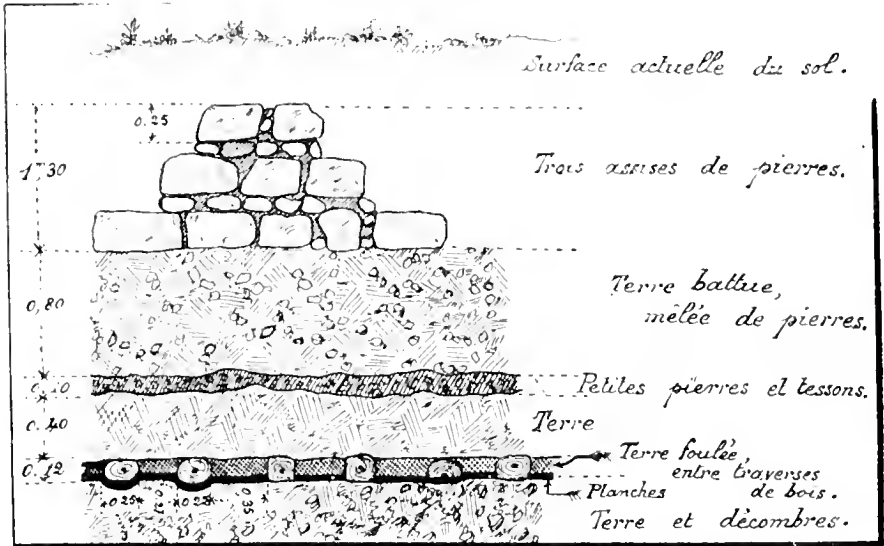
Mousso, soubassement d'une muraille. D'après un croquis de M. Schumacher
